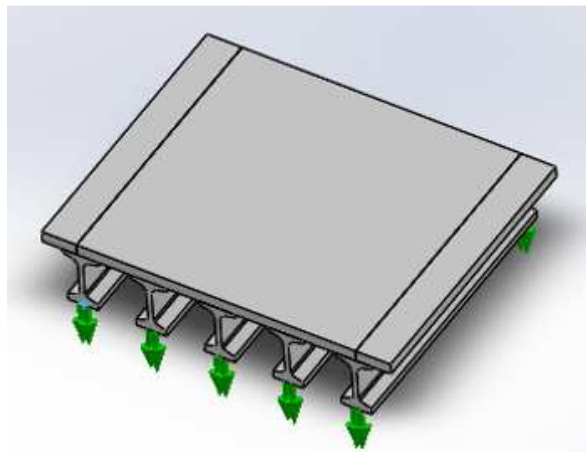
Vista predominantemente superior de un puente de 5 vigas tipo D, SolidWorks.
